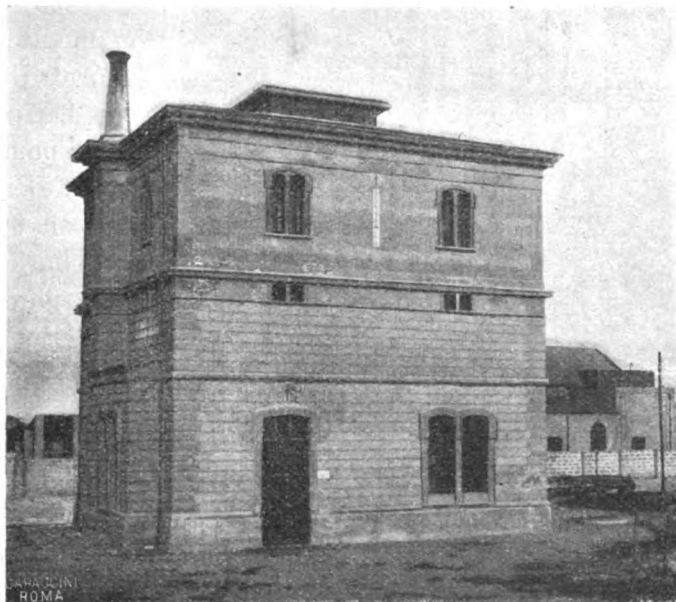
Fabbricato del Rifornitore-depuratore (prospetto principale verso Sud).
